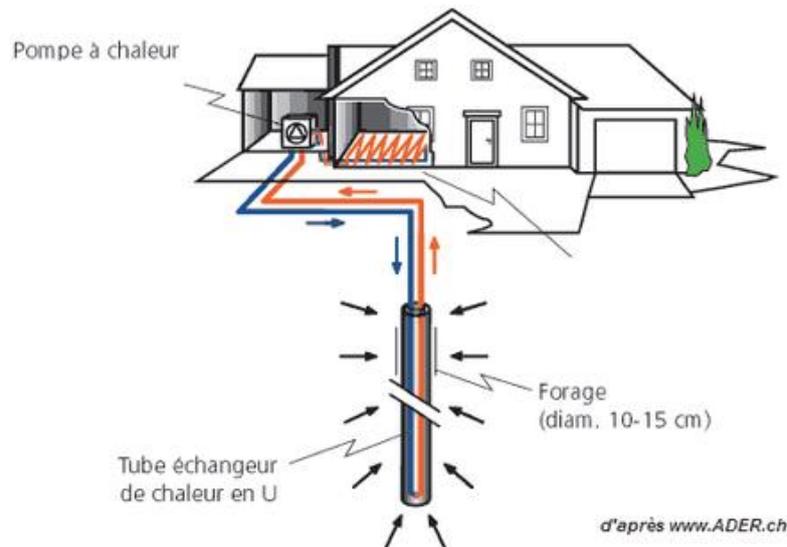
Coupe schématique d'une installation géothermique sur sonde (source : www.geothermie-perspectives.fr)
